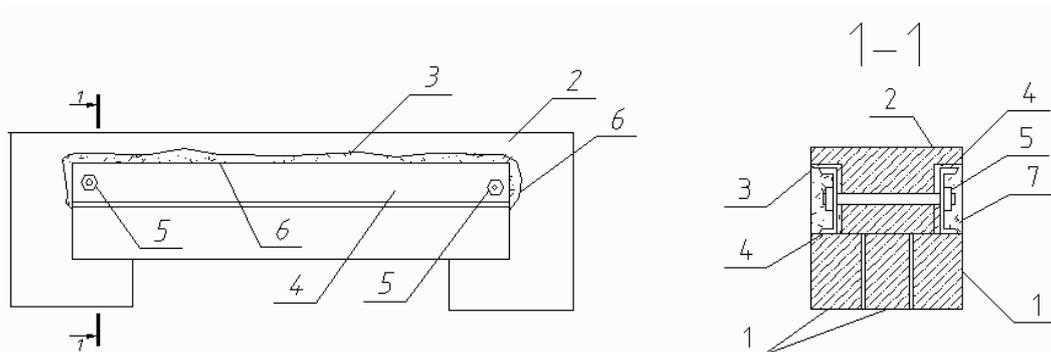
Усиление перемычек устройством разгружающих балок в штрабах: 1 – усиливаемые перемычки; 2 – кирпичная стена; 3 – штрабы в стене для установки разгружающих балок; 4 – разгружающие балки из прокатного металла (швеллер, уголок); 5 – стяжные болты, установленные в просверленные отверстия; 6 – зачеканка пазов цементно-песчаным раствором; 7 – штукатурка по сетке
